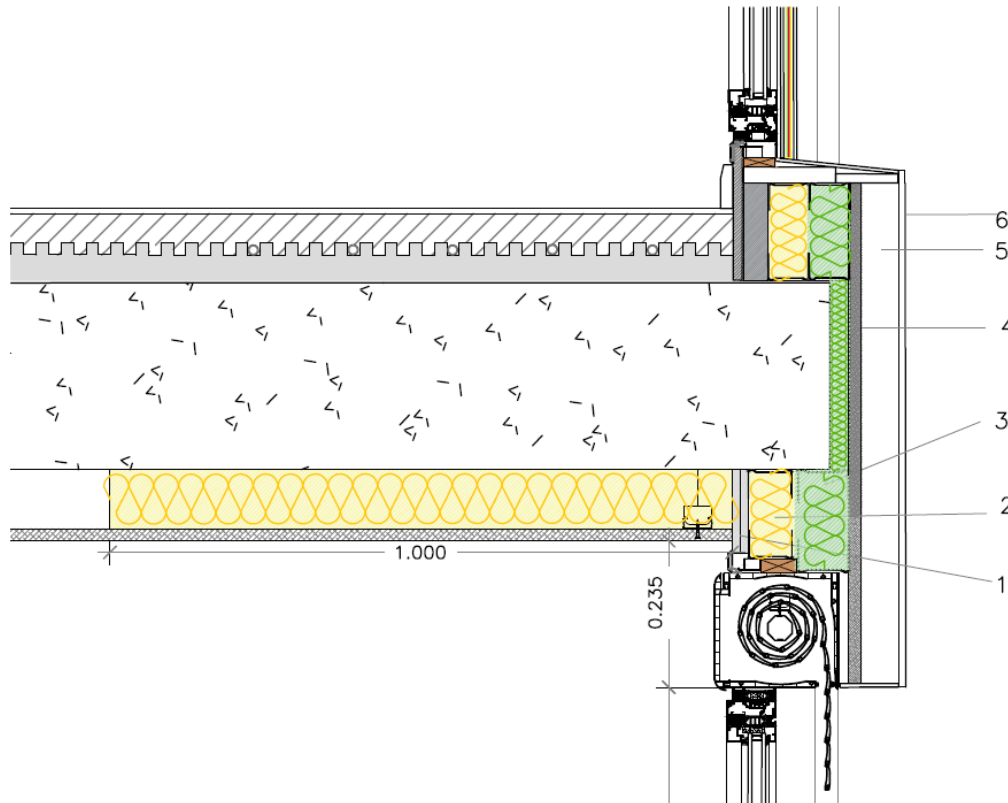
Sección constructiva, corte vertical, de la propuesta de fachada ligera, tabiquería seca, a estudio.
